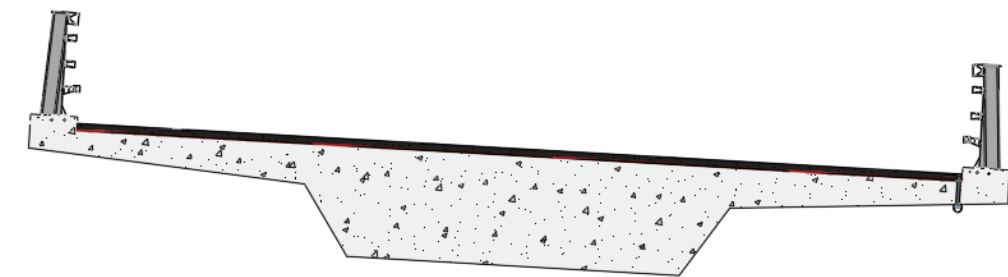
Sección tipo losa hormigón pretensado en los estribos.
